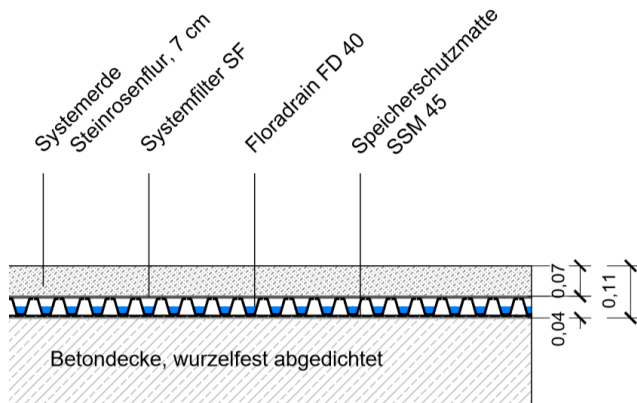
Aufbau extensive Dachbegrünung HTI (nach GOLLER, 2016)
